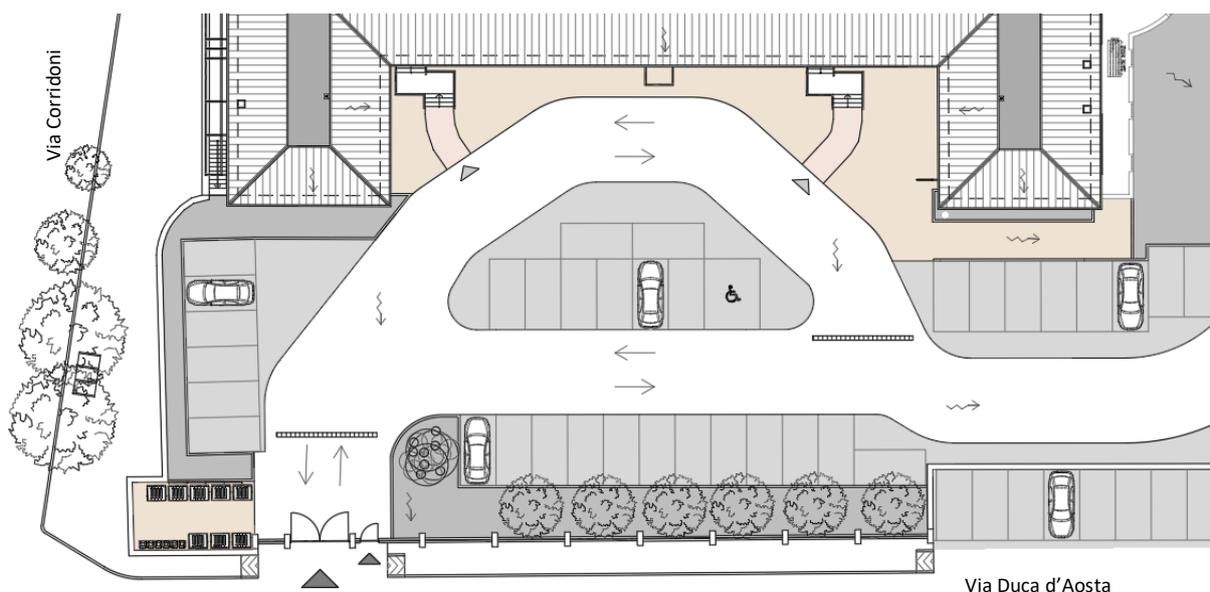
Stralcio di tavola "planimetria lotto di progetto", lato via Duca d'Aosta
